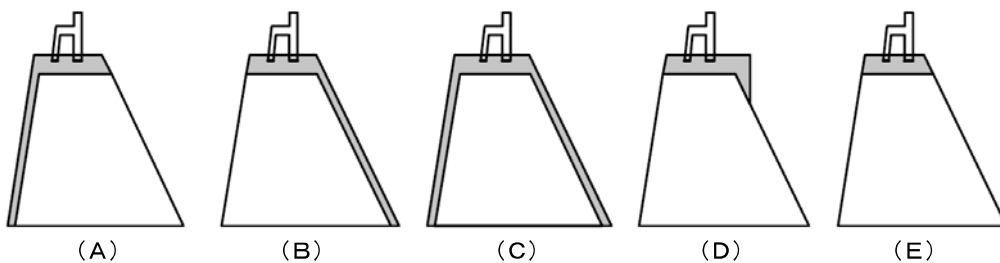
基礎コンクリート及び補強コンクリートの打設
